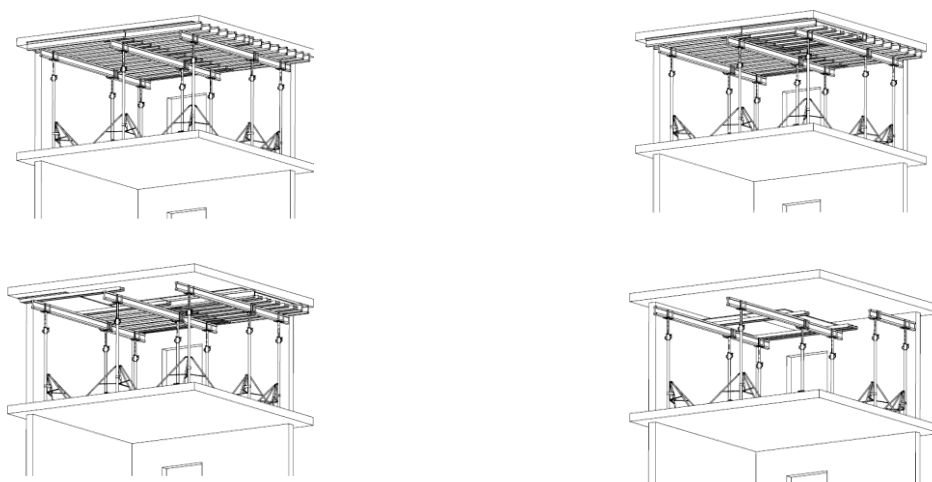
Этапы разборки опалубки перекрытия
